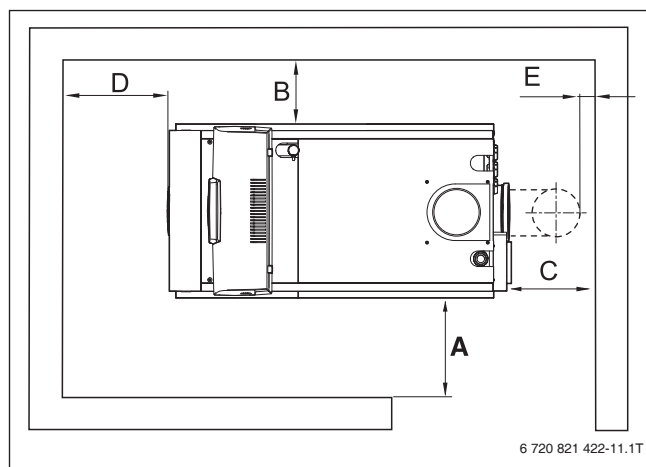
Wandabstände Logano plus KB372 (Rechtsausführung)
